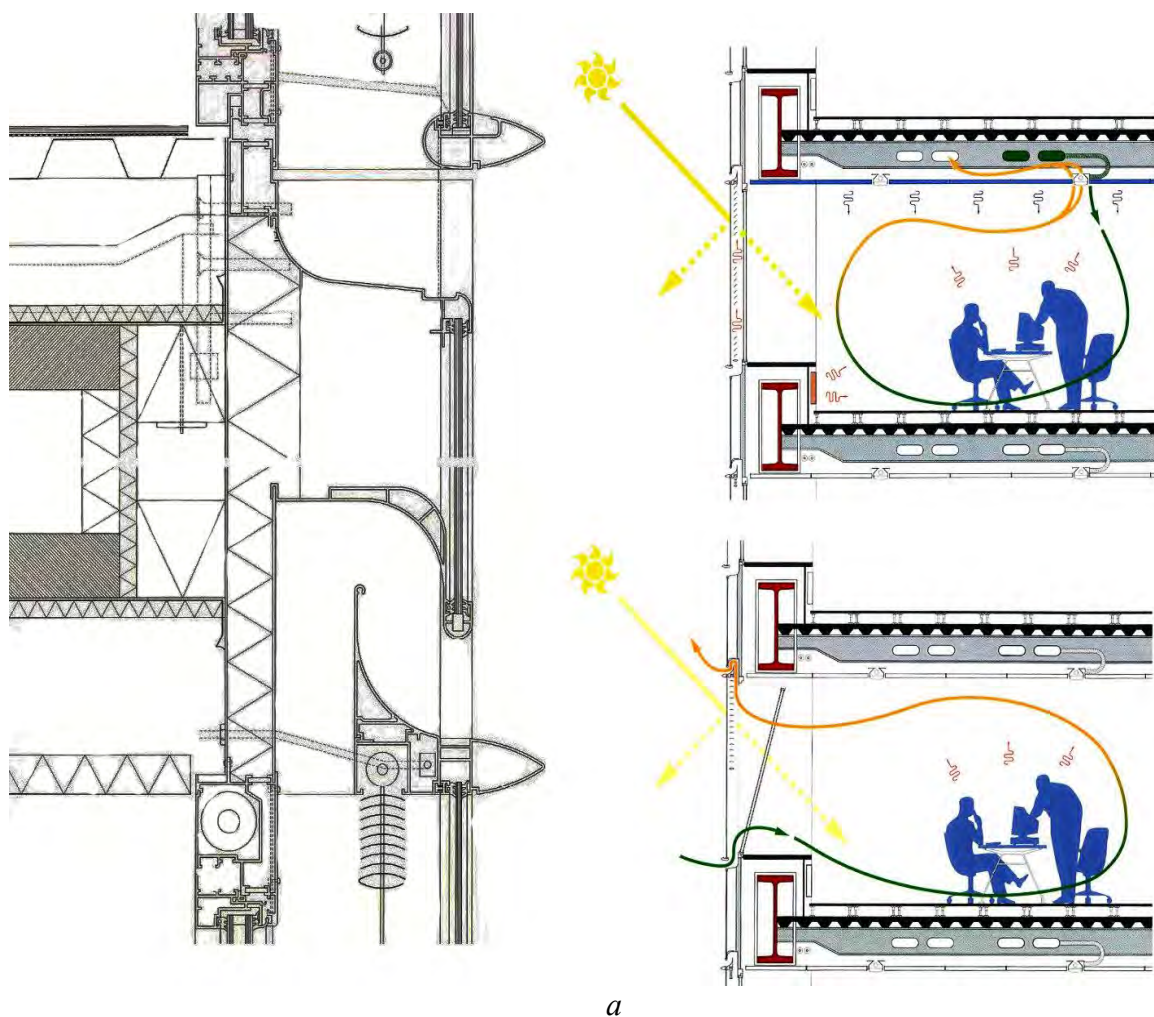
Схемы конструкций наружных светопрозрачных ограждений:
